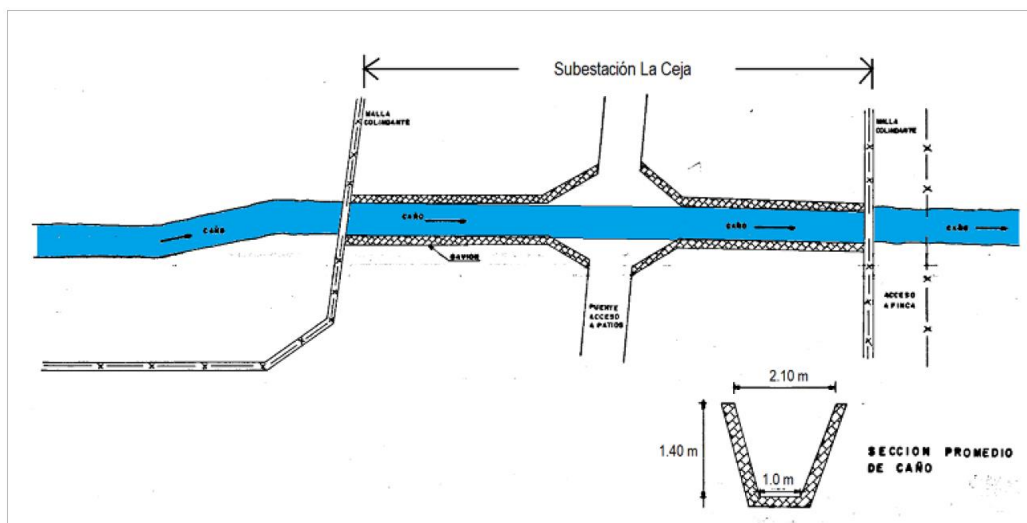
Esquema en planta del alineamiento del canal y sección transversal de canal de la quebrada San Joaquín al interior de la Subestación la Ceja
